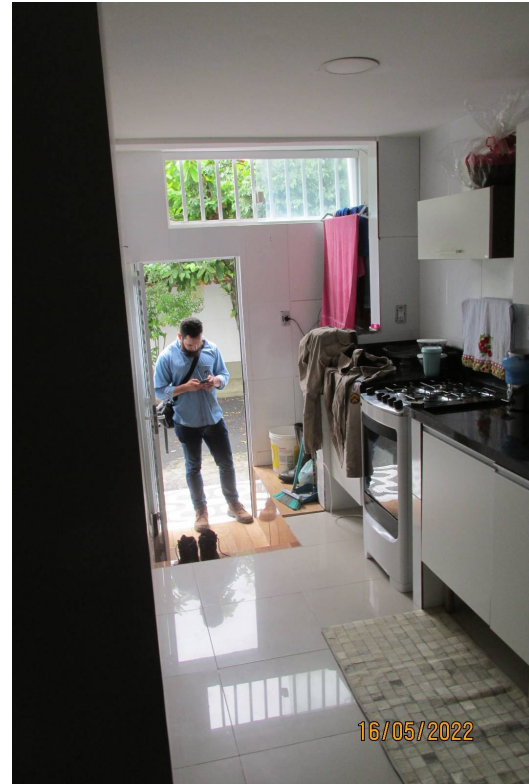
Vista, a partir do interior do dormitório, do corredor de ligação entre a cozinha, dormitório e ao corredor do banheiro e área técnica; um depósito dessa terceira unidade.
